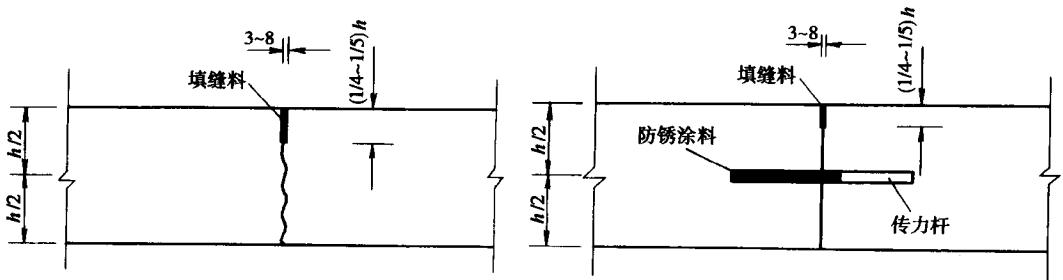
横向缩缝构造(尺寸单位:mm)
